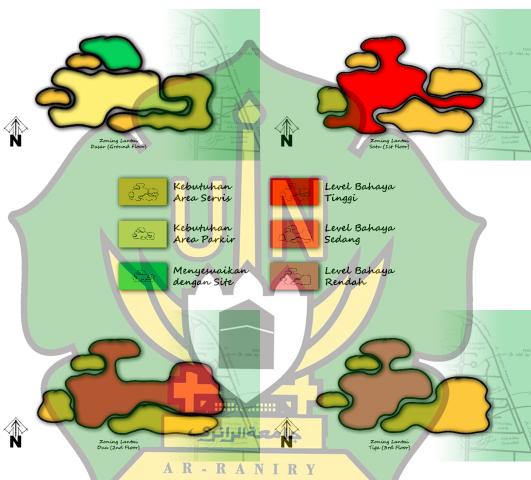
Organisasi Ruang Lantai Satu (*Ist Floor*) (Sumber: Analisa Pribadi)
